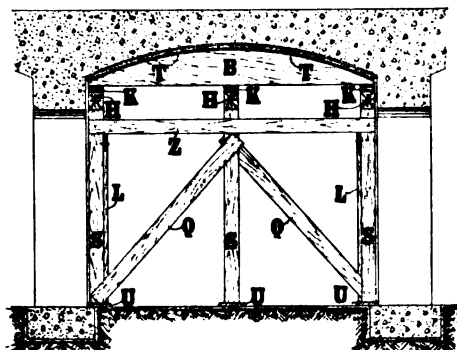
Stampfgerüst für stark beanspruchte Kellerdecken.
